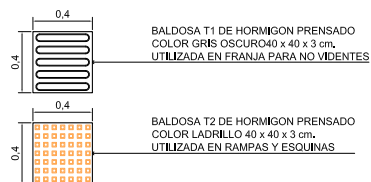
Detalles técnicos y constructivos para la intervención. 2012.
